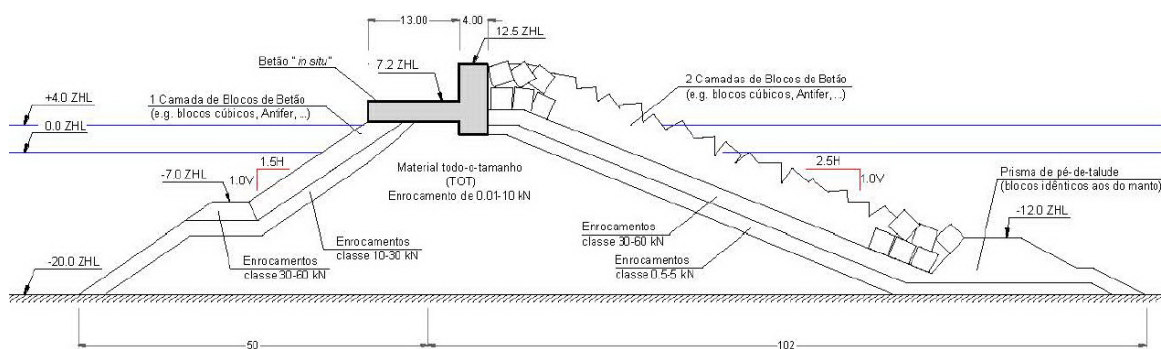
Perfil transversal tipo para prolongamento do quebramar exterior. (IHRH, 2013)
